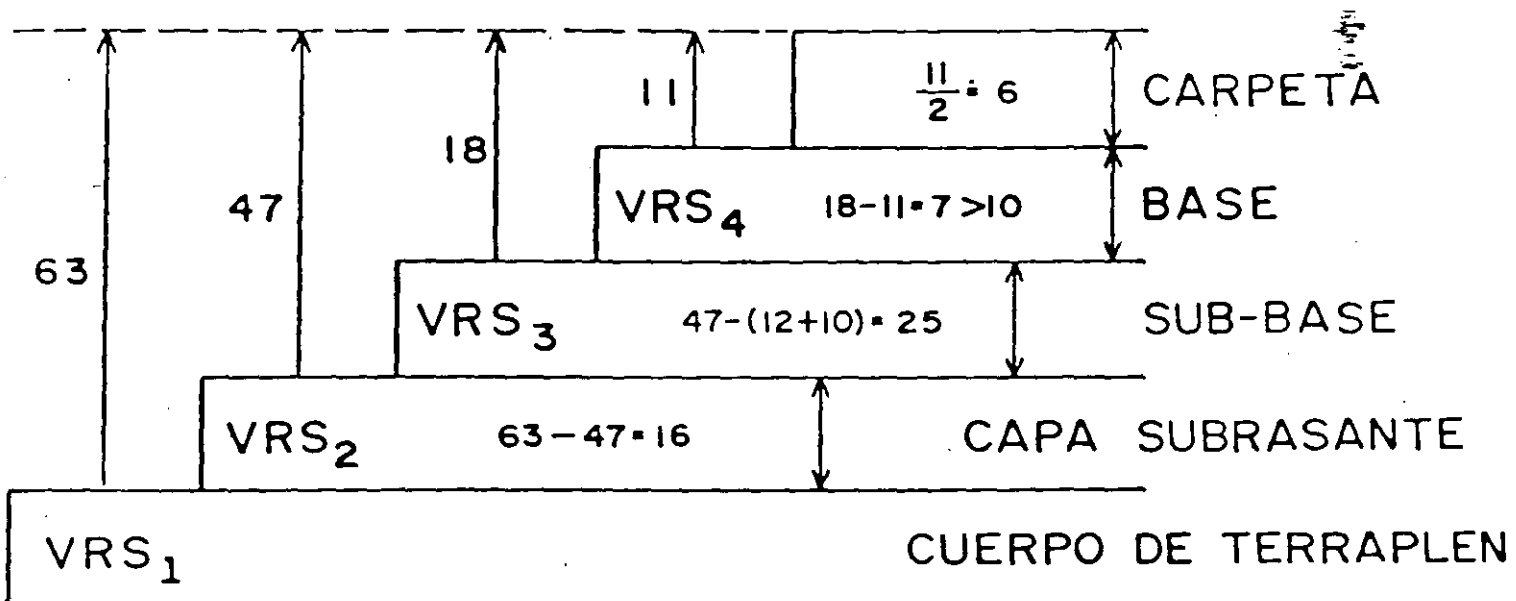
Ejemplo: gráfica para diseño estructural de carreteras con pavimento flexible
